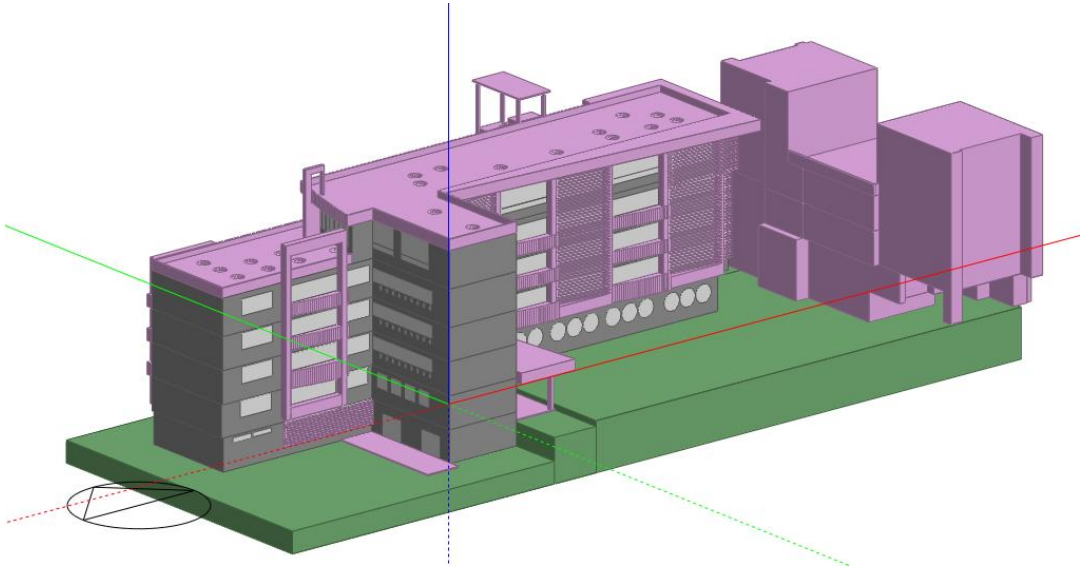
Bloque componentes para detalles del Edificio de Ingeniería Eléctrica (Sacado del modelado en *DesignBuilder*).
